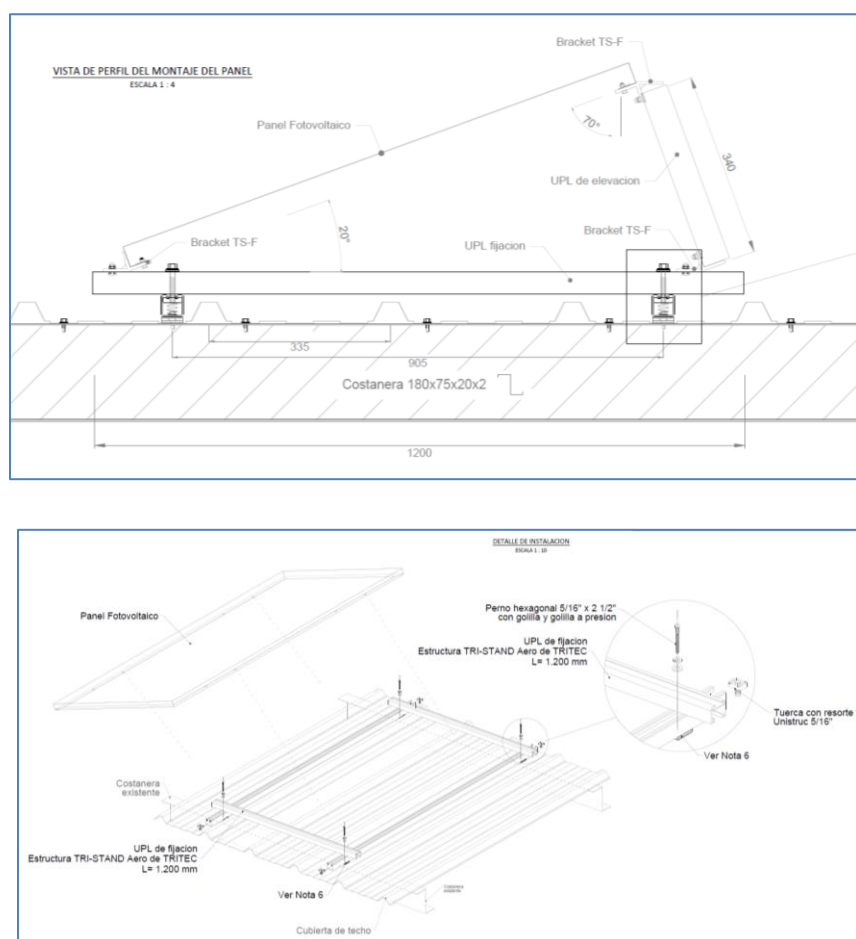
ubicación del panel sobre las costaneras de techo.-
